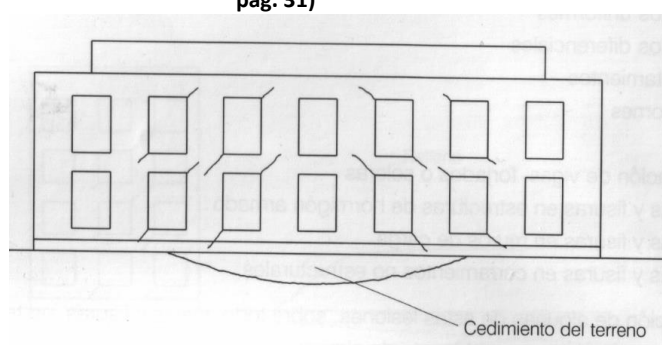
Grietas y fisuras. Asientos intermedios en muros. Fuente: Boubeta Santomé, J.M. (2008, pág. 48)
